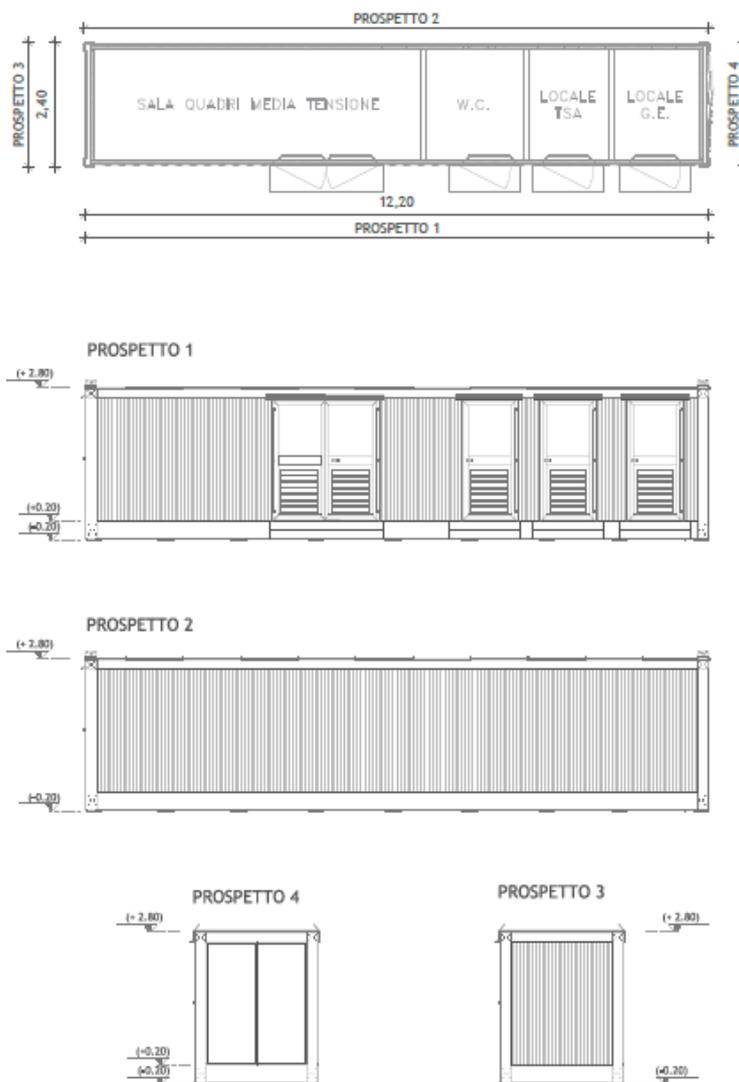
Pianta e prospetti dell'Edificio Quadri
